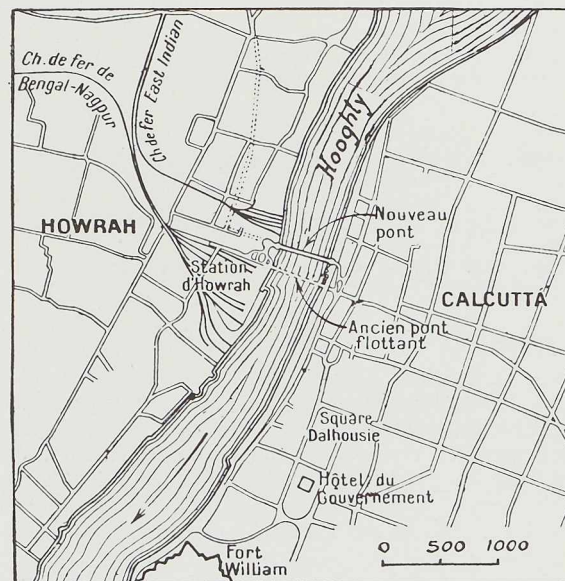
Plan de situation du pont de Howrah sur l'Hooghly.
